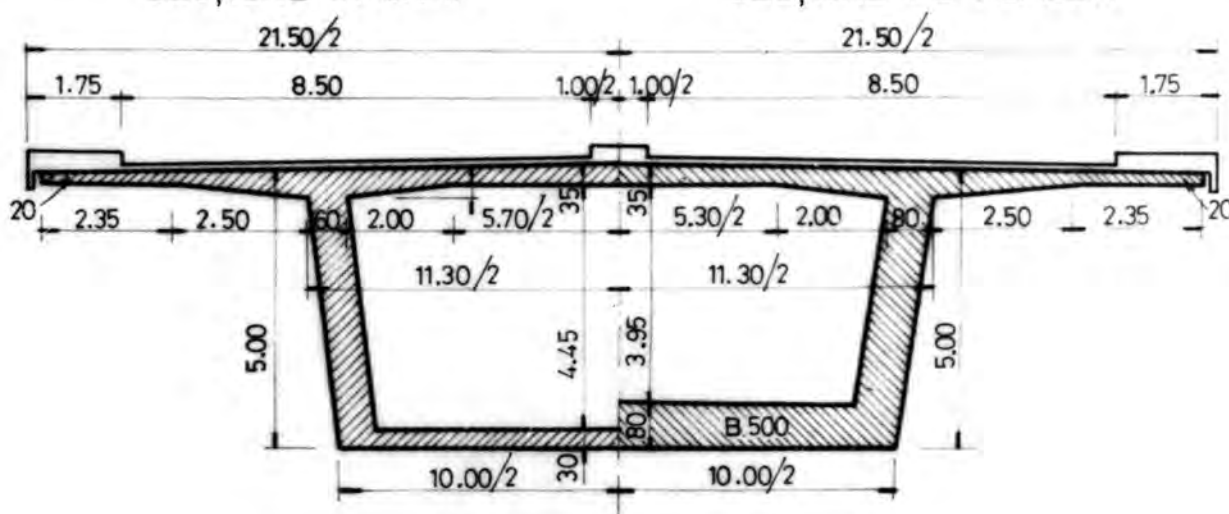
Pod albia minoră. Cadru din beton armat precomprimat cu deschideri de 100 m
